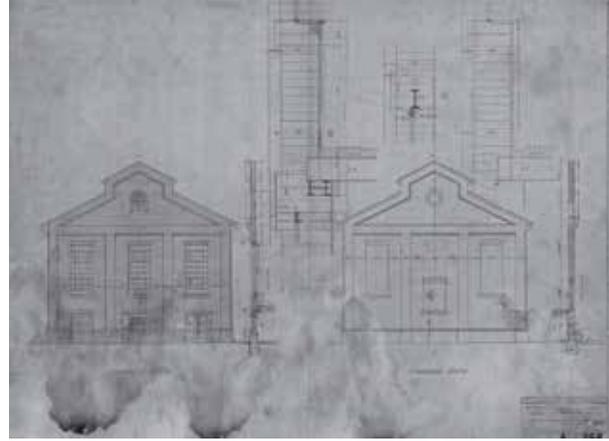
Plano A-868 Proyecto para la Nueva Planta Eléctrica Casa, mostrando las fachadas oeste y este. Sin fecha, contrato núm. 28646. AHF.
